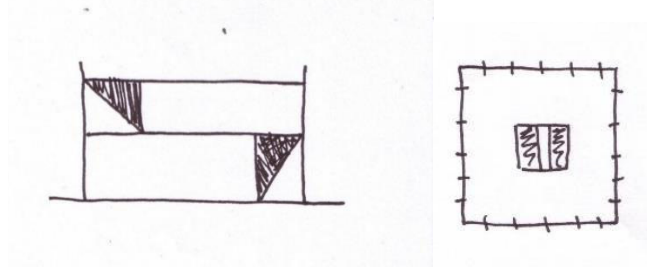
Bocetos de planta por Alejandro Aravena.
